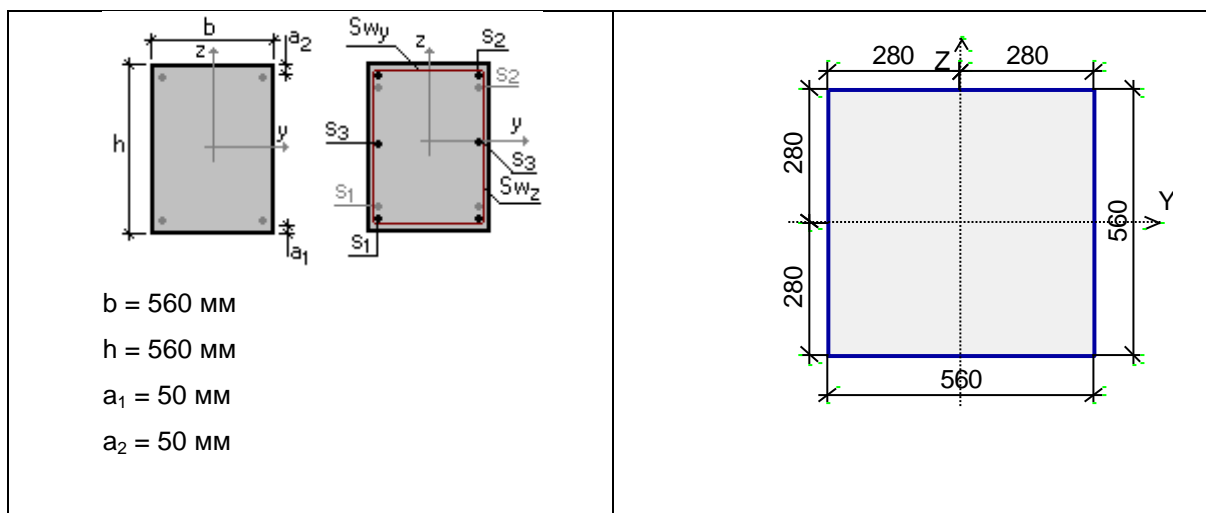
Размеры и схема армирования сечений колонн вдоль стен с отм. 0.000 до отм. +17.200 м (участок армирования 1) (а) и выше отм. +17.200 м (участок армирования 2) (б).
